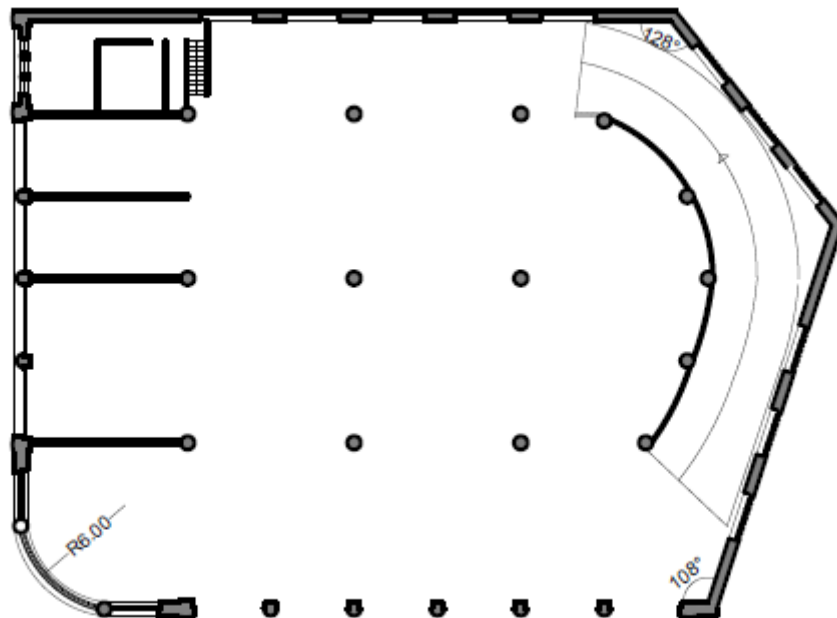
Planta Piso 0 Existente, escala 1/500 (Autora, 2019)
